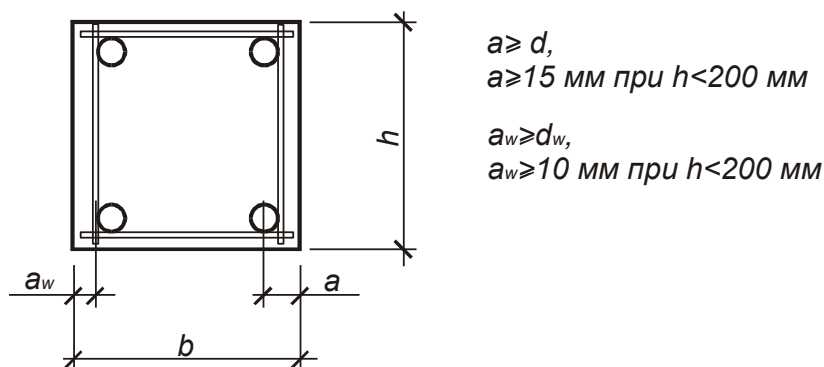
Размещение арматуры в поперечном сечении элементов
